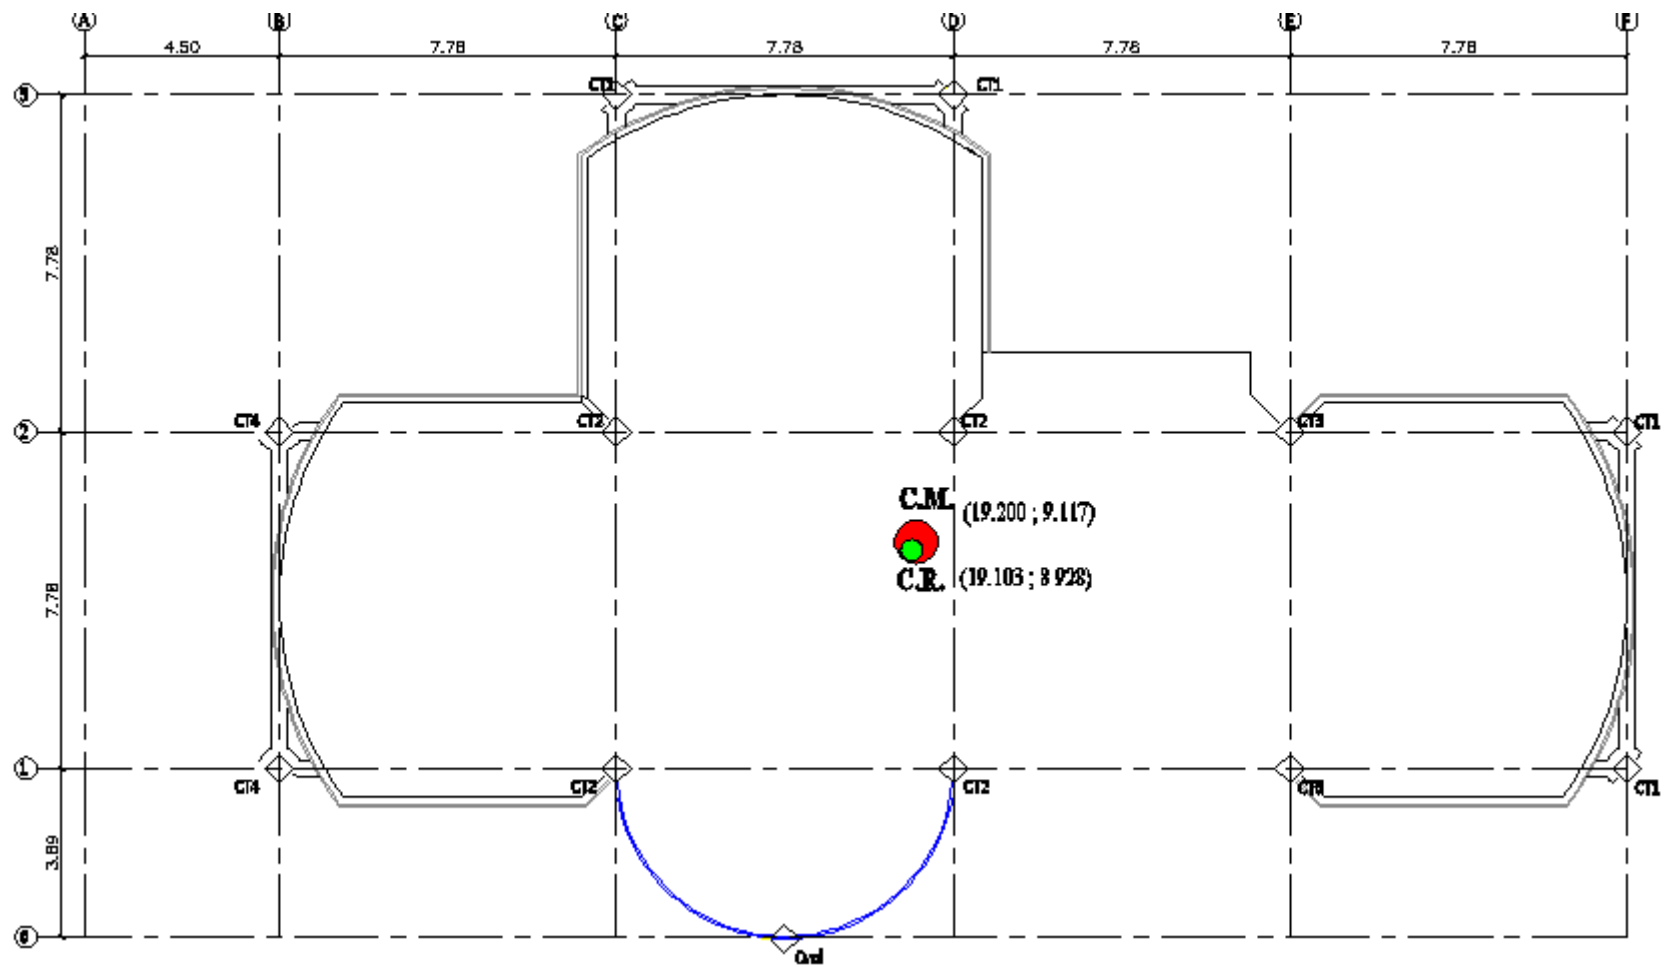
Centro de Masas y Rigidez de las Losas N+5.96, N+8.84
